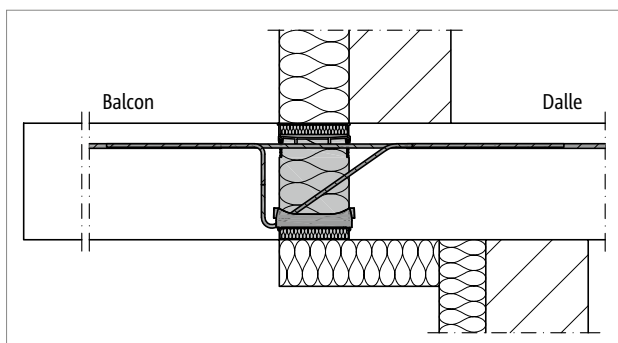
Schöck Isokorb® XT Type K : Raccordement pour plancher indirect et ETICS
